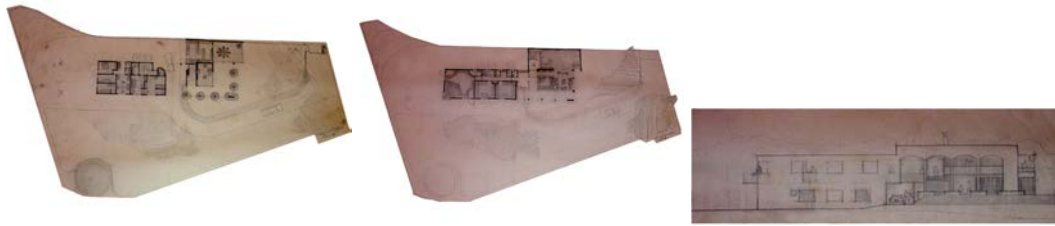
a 8 - Projeto de reforma para a Casa Claudio e Carla Lunardelli: Planta térreo; Planta do primeiro pavimento; Corte. Projetos de Eduardo Longo, São Paulo, 1972. Fonte: Arquivo de Eduardo Longo.
